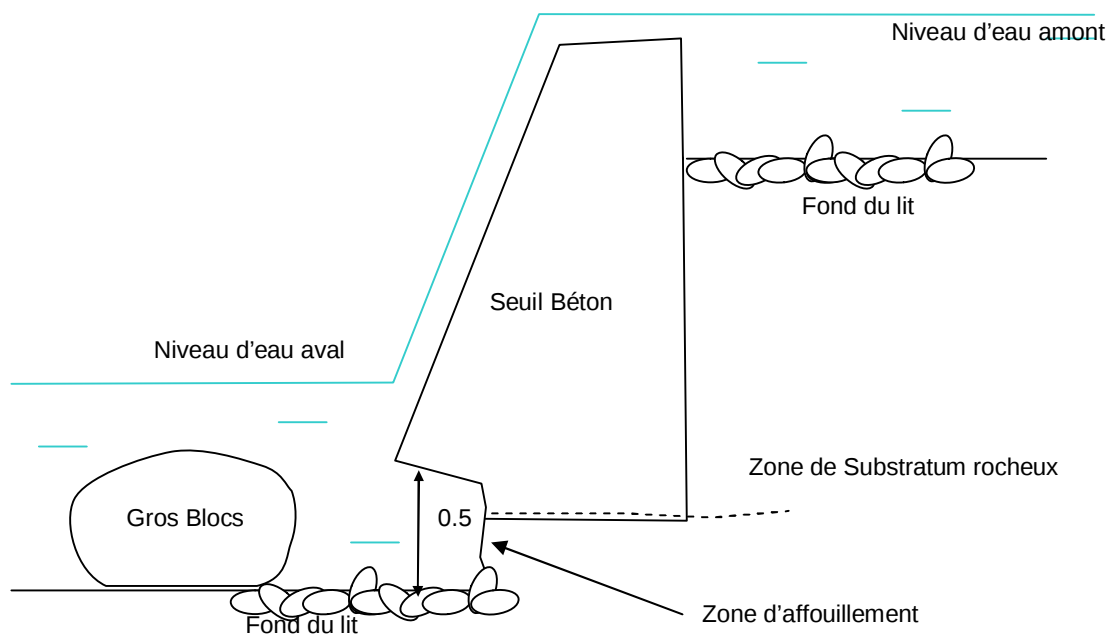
schéma coupe du seuil béton situé en rive gauche (POYRY, 2011)
